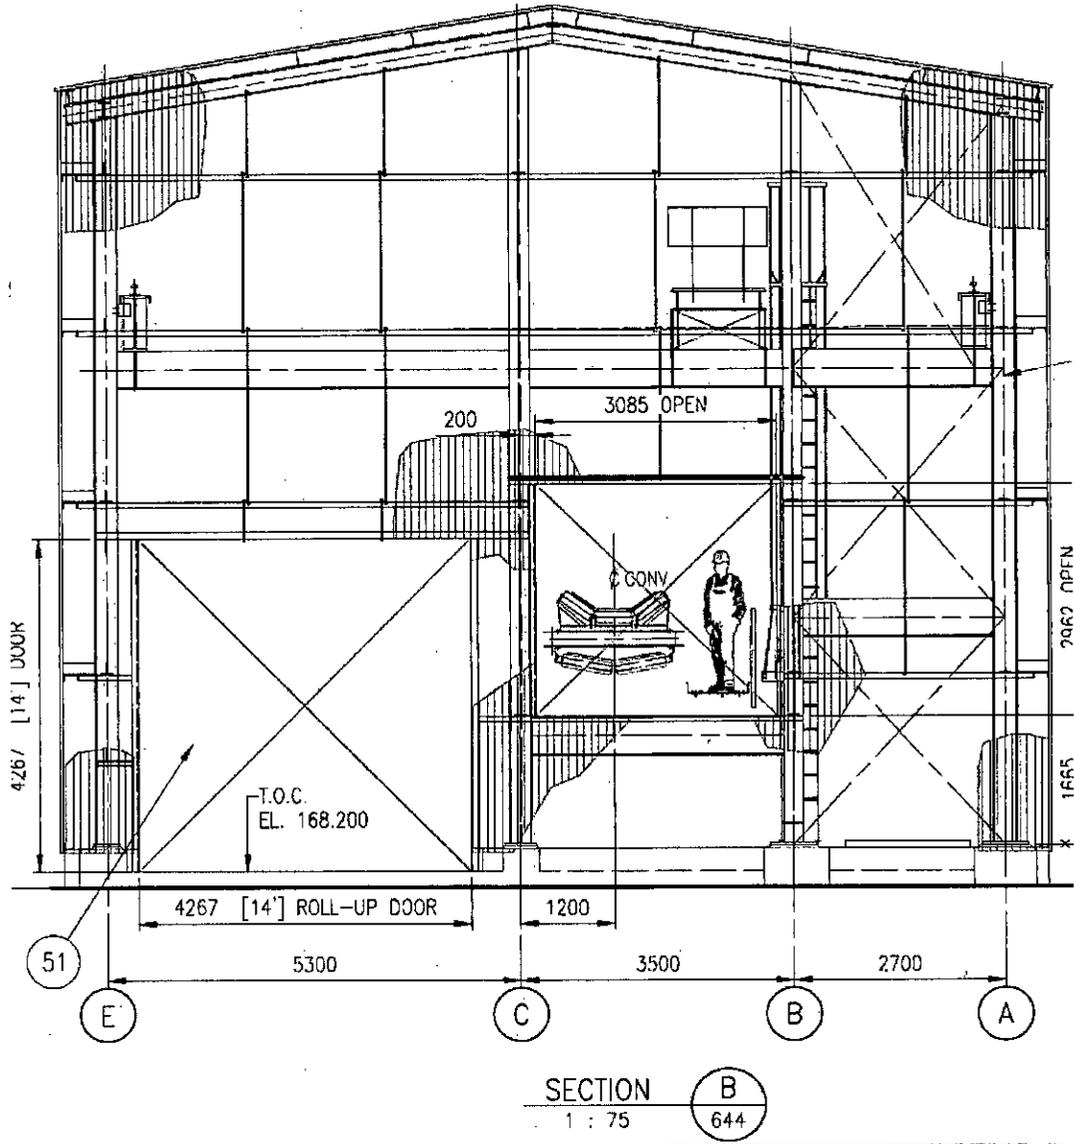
VISTA DE PLANTA EDIFICIO DE ACCIONAMIENTO, FAJA 830-CB-110
